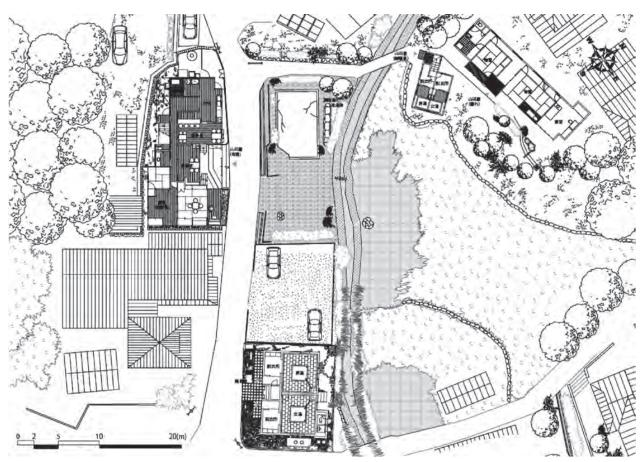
明礬温泉地区 旅館 Y・鶴寿泉 1 F 平面図
